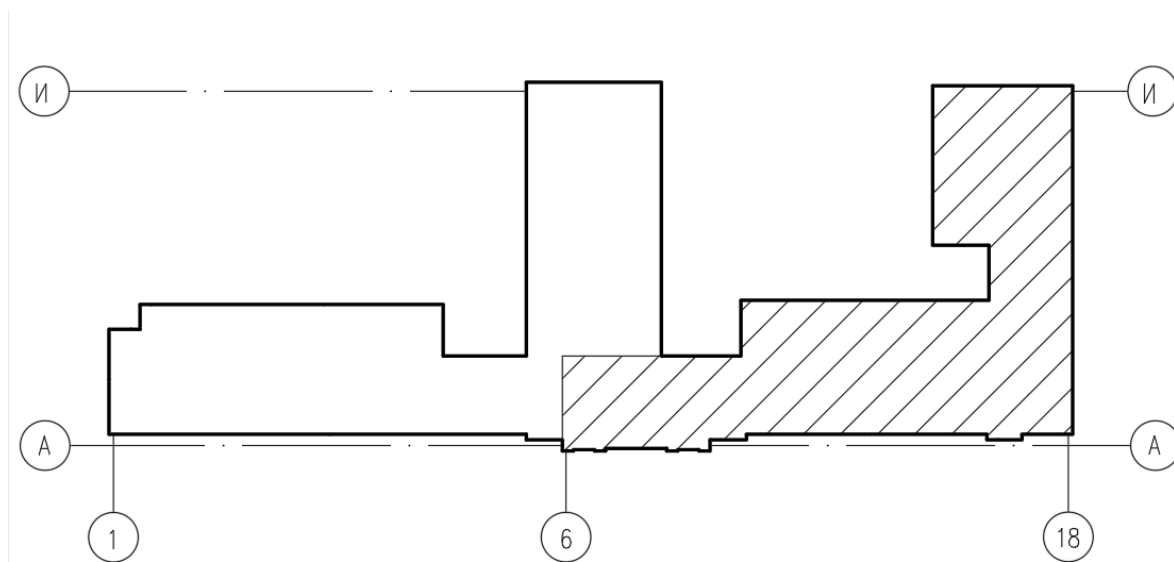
Форма и размеры в плане учебного корпуса №18 БНТУ
